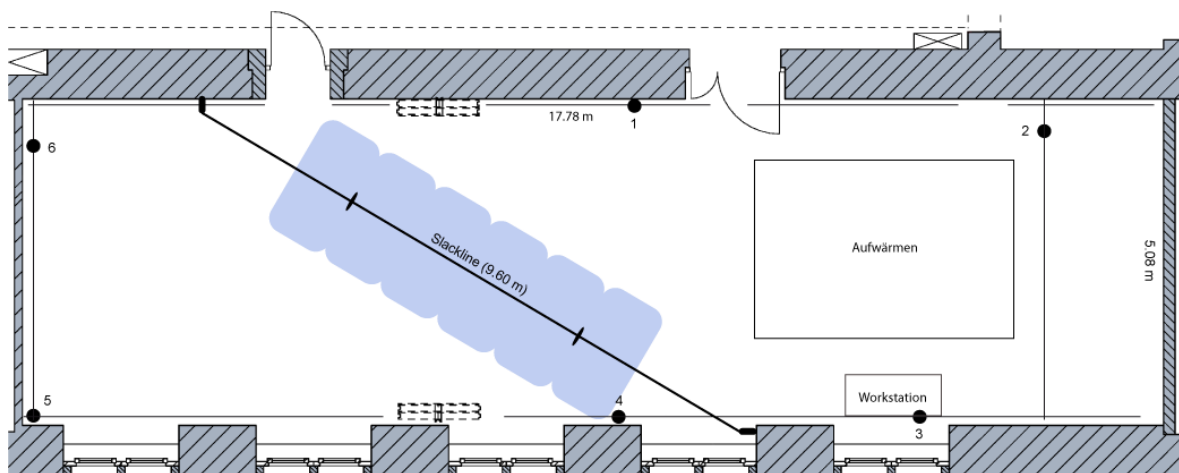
Grundriss des sportwissenschaftlichen Labors mit Kamerapositionen 1-6.
